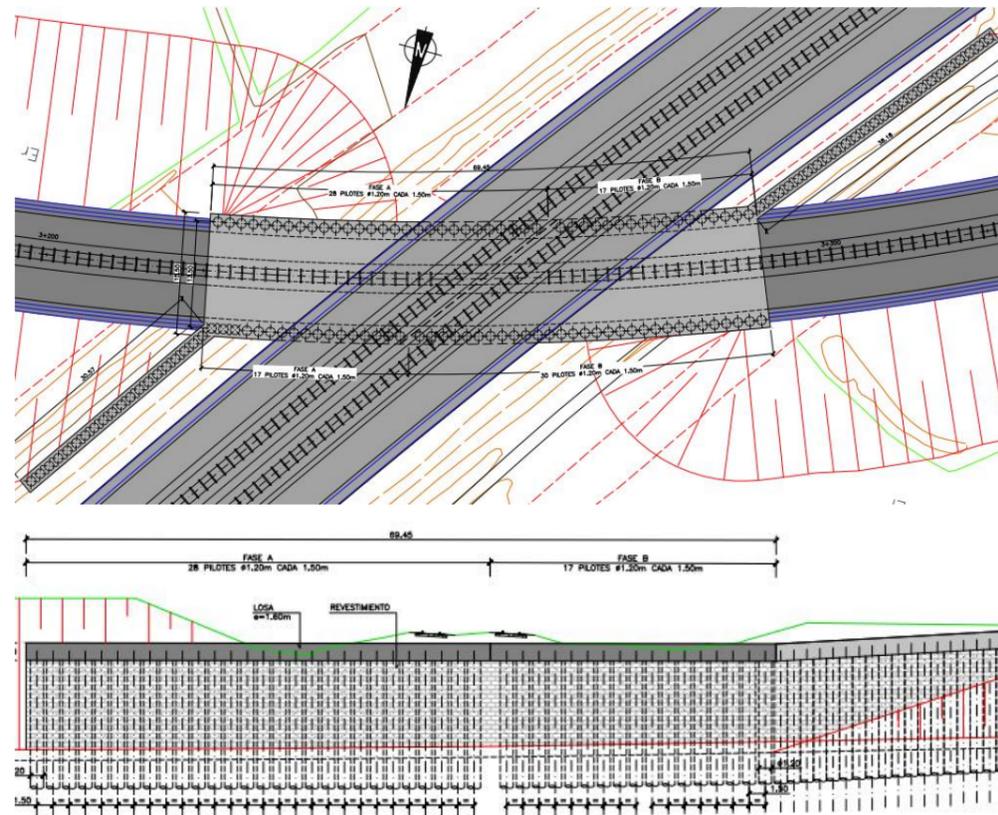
PLANTA Y ALZADO DEL PASO INFERIOR P.K. 3+240
